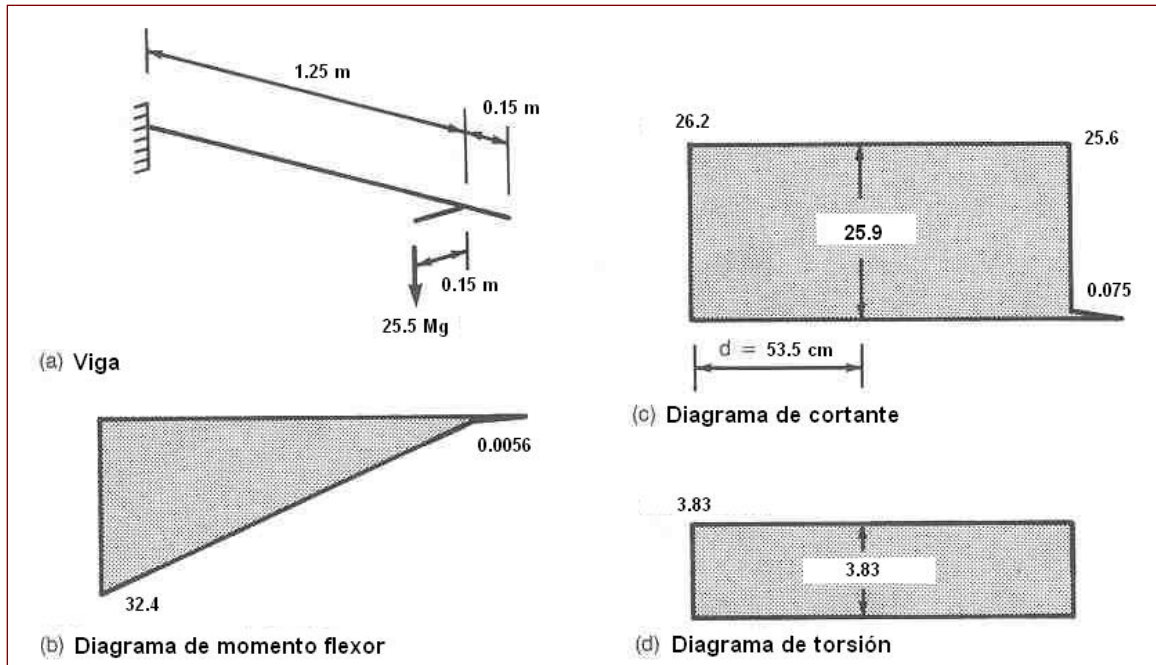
Viga en voladizo—Ejemplo 6-2
